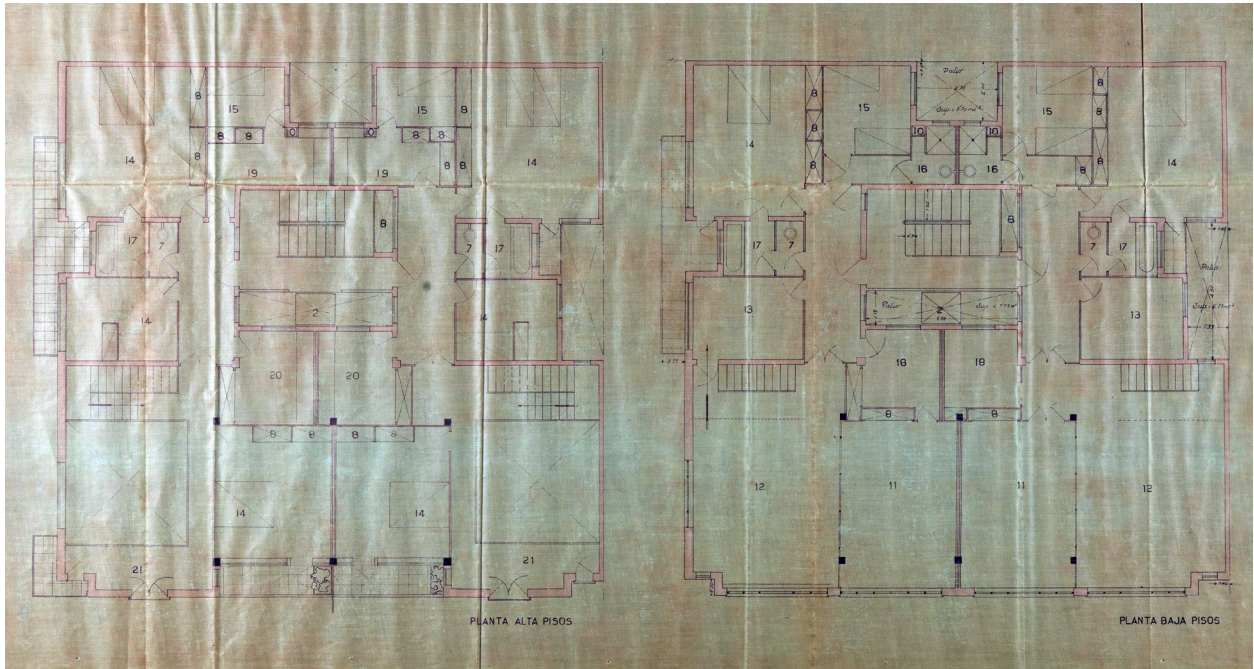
Plantas tipo del primer proyecto de Sert. Plano sin numerar (Detalle). Expediente Fo-3756/1929. 1929. Arxiu Contemporani de Barcelona
